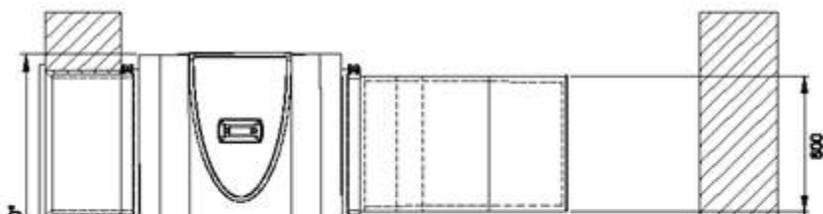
Vista dall'alto - LI 11TES (Installazione a parete con canale aria lato aspirazione e lato scarico)
